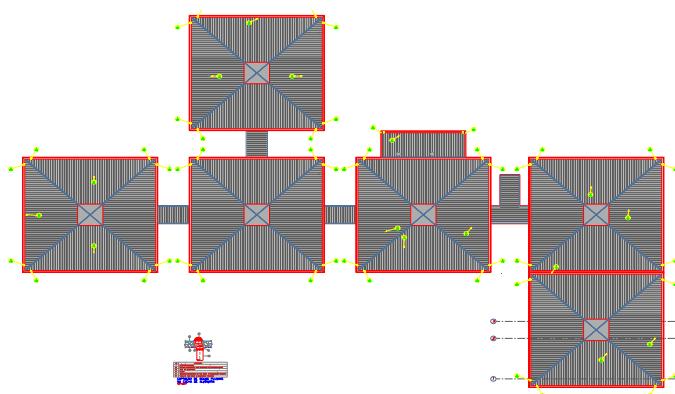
Projeto executivo da CMEI Teresinha Alves Mian cobertura em estrutura metálica com telhas de chapa de aço galvanizado, trapezoidal, espessura de 050mm. Com faces aparentes pré-pintada na cor vermelha (20micra), referencia VW – 001 Dicom.
